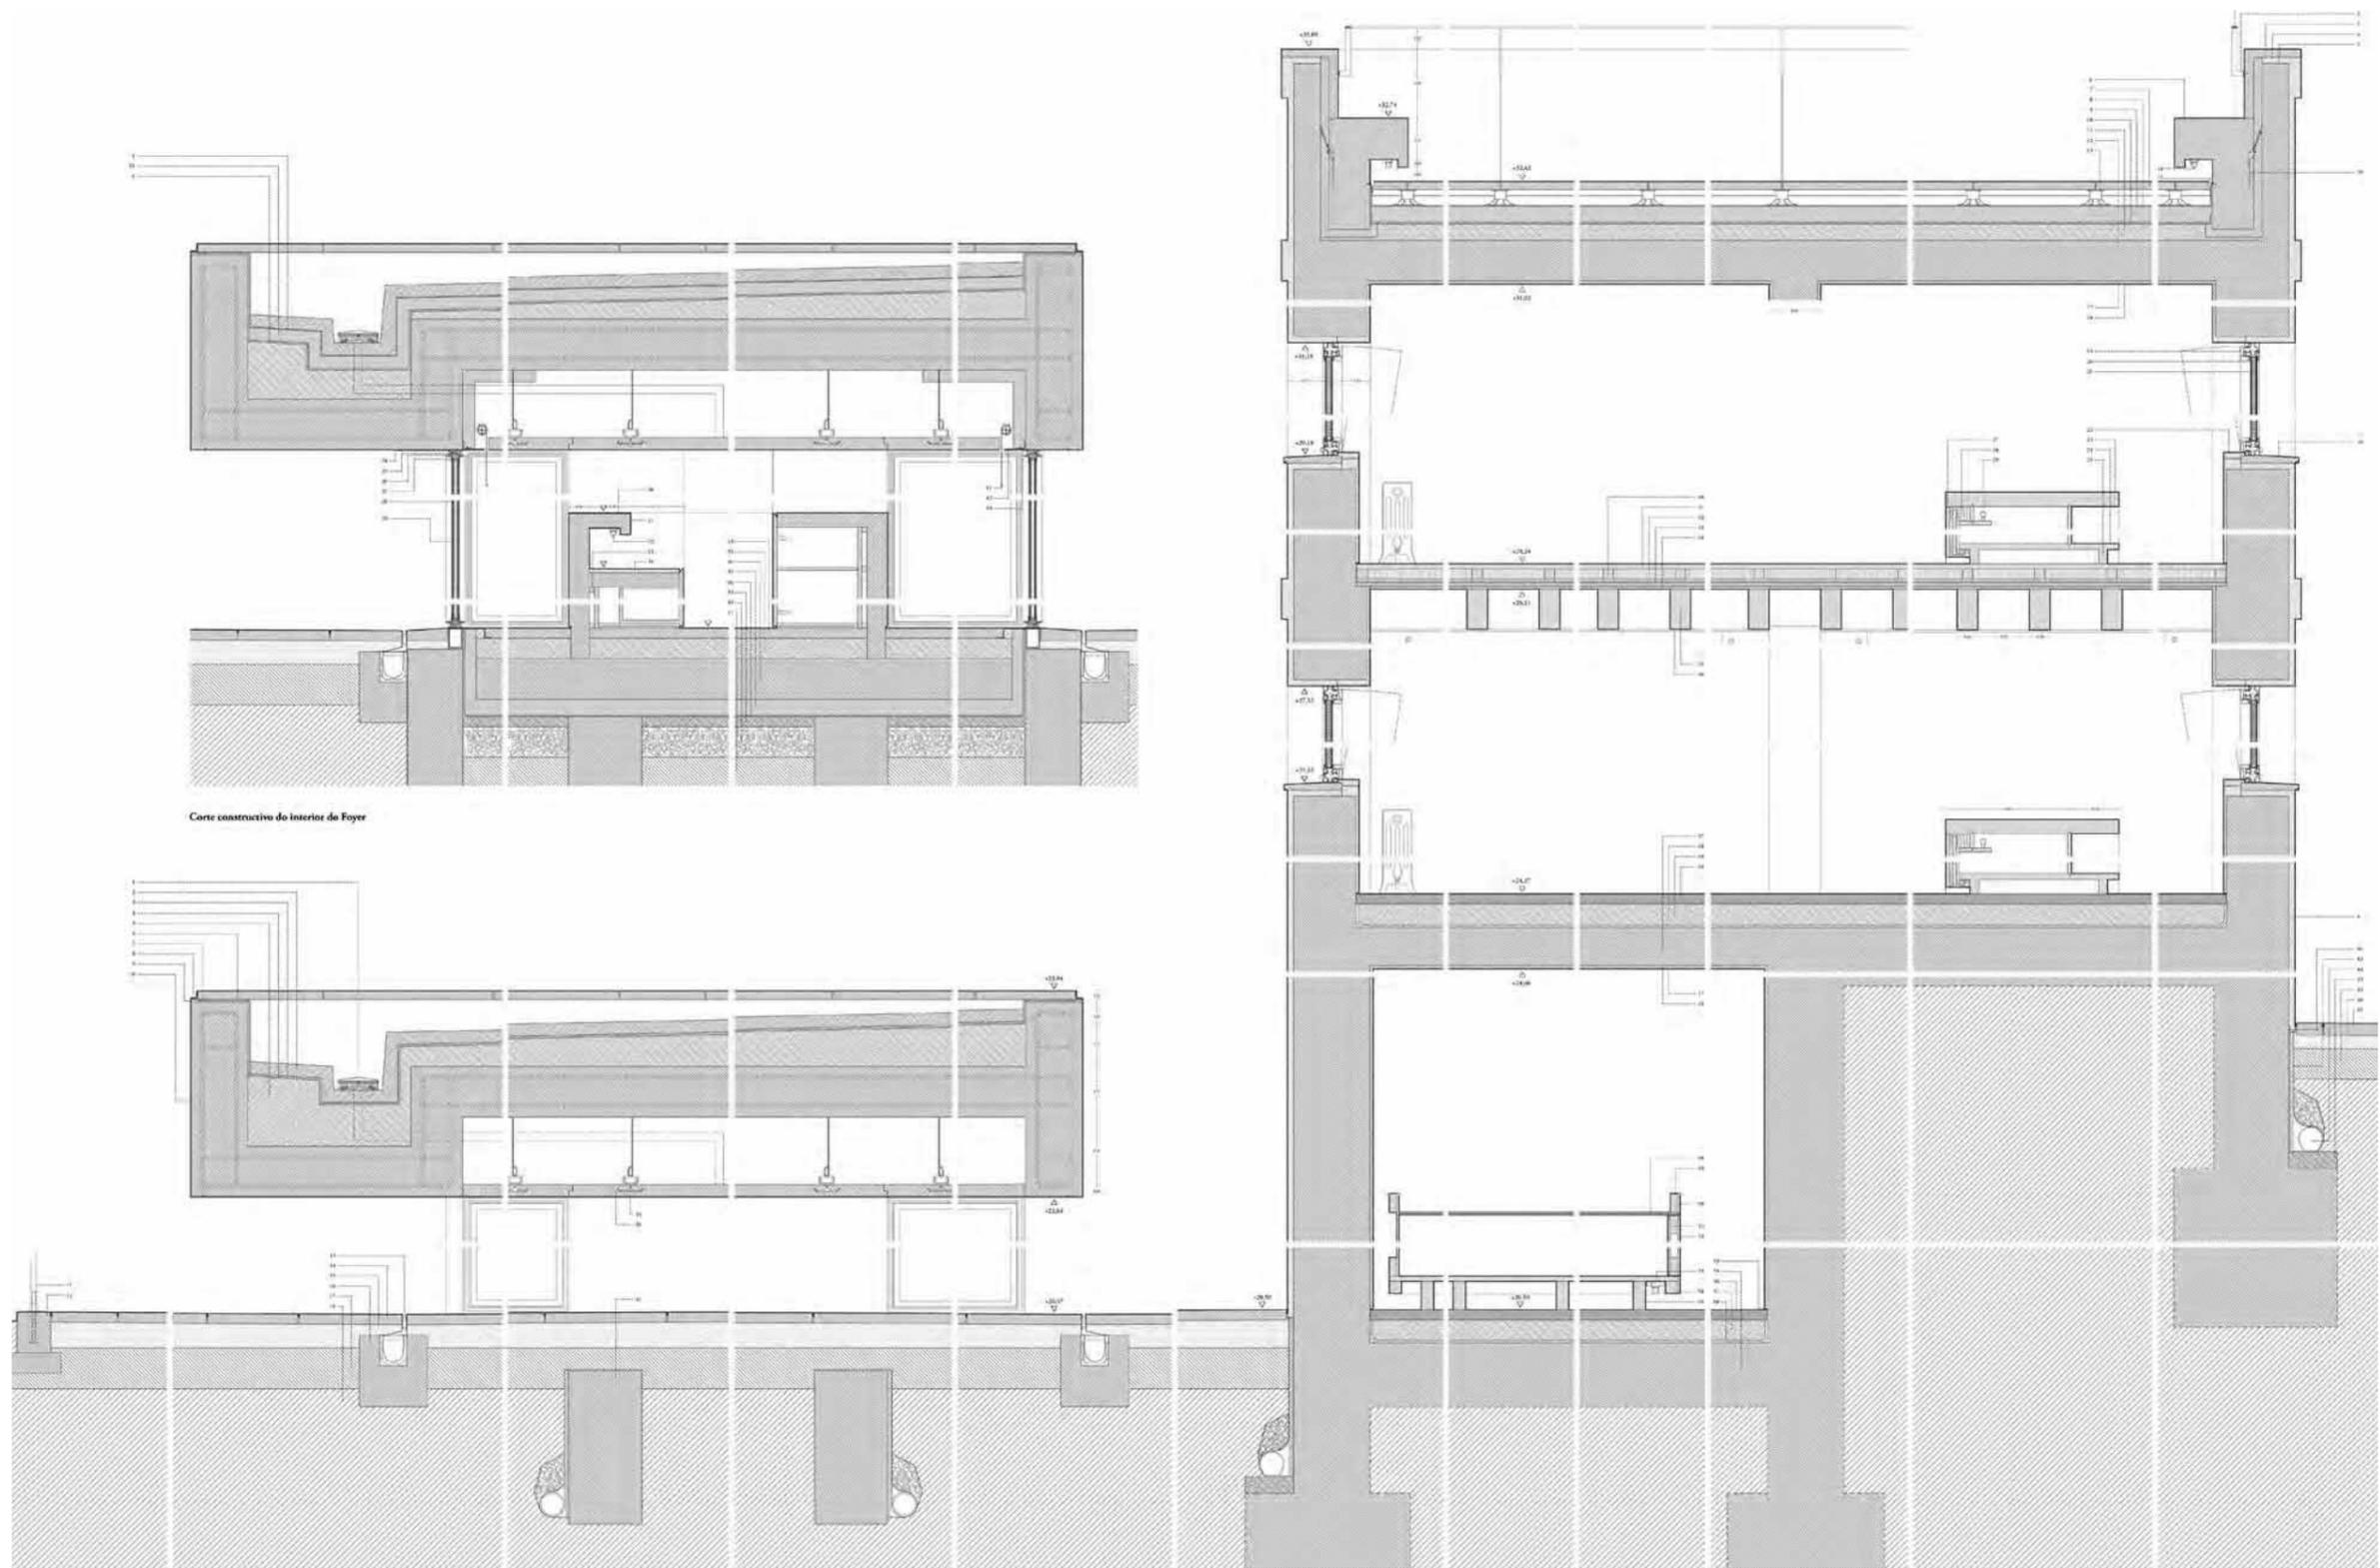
Pormenor construtivo (legenda no desenho em anexo)
